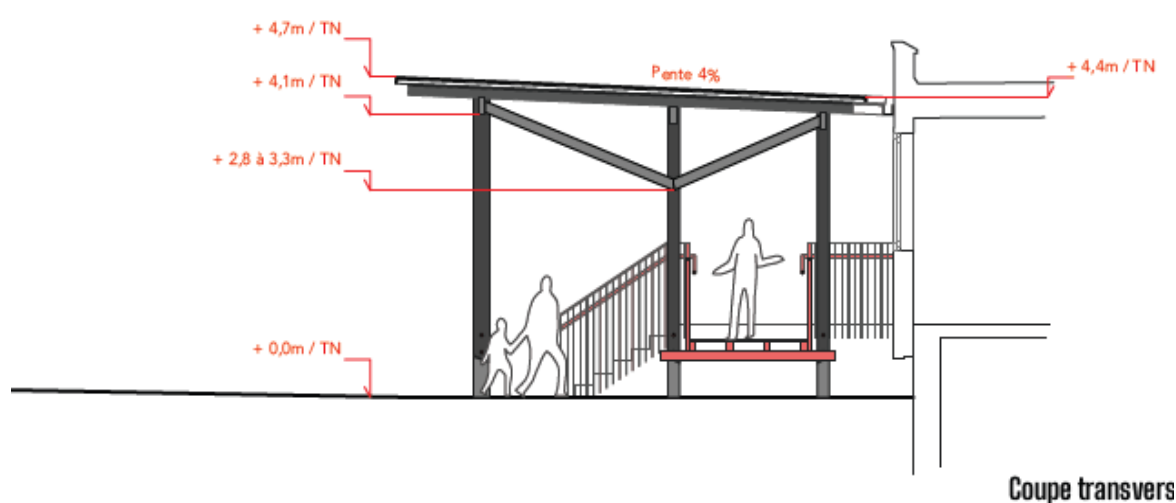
Coupe transversale de la Halle-Parvis projetée
